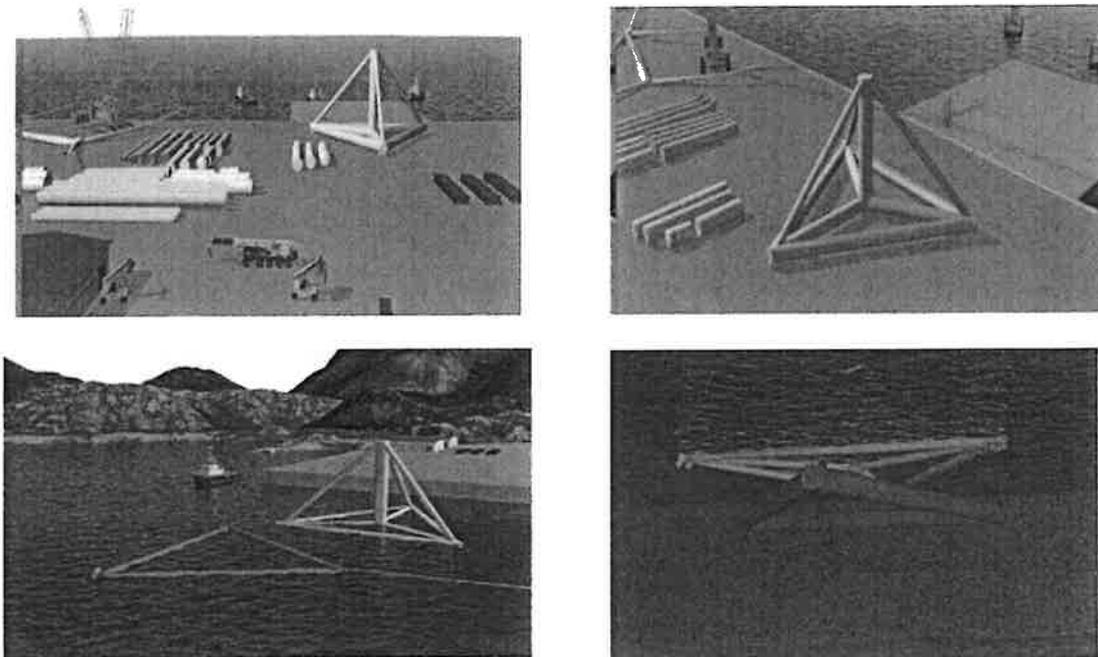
Fasi di assemblaggio di una piattaforma galleggiante
